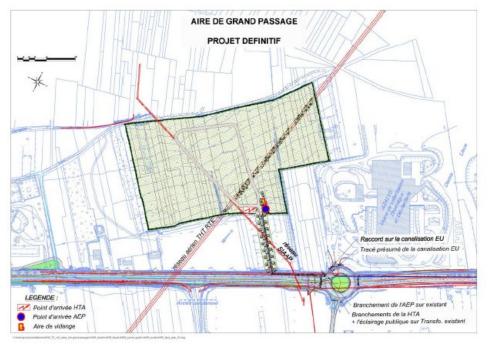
plan masse de l'étude de faisabilité (février 2016)
